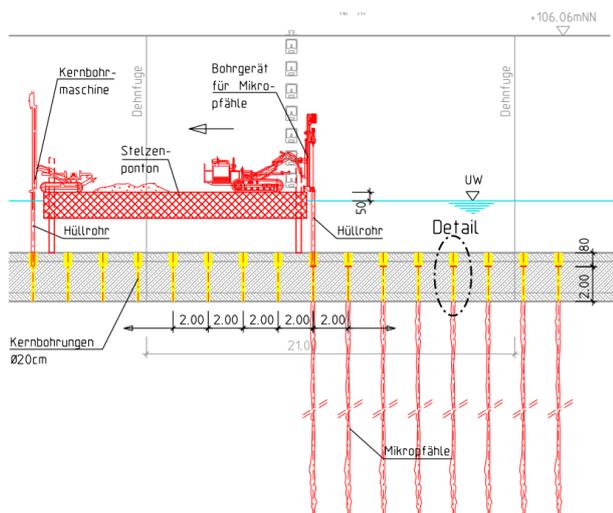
Längsschnitt Kammersohle – Einbau Auftriebssicherung
